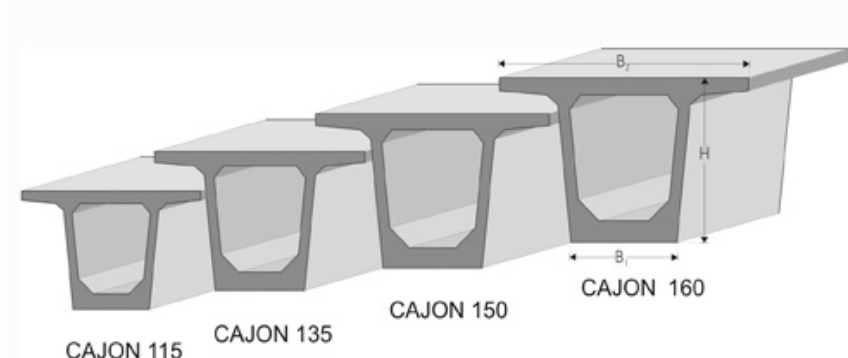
Secciones transversales tipo viga cajón [32]
